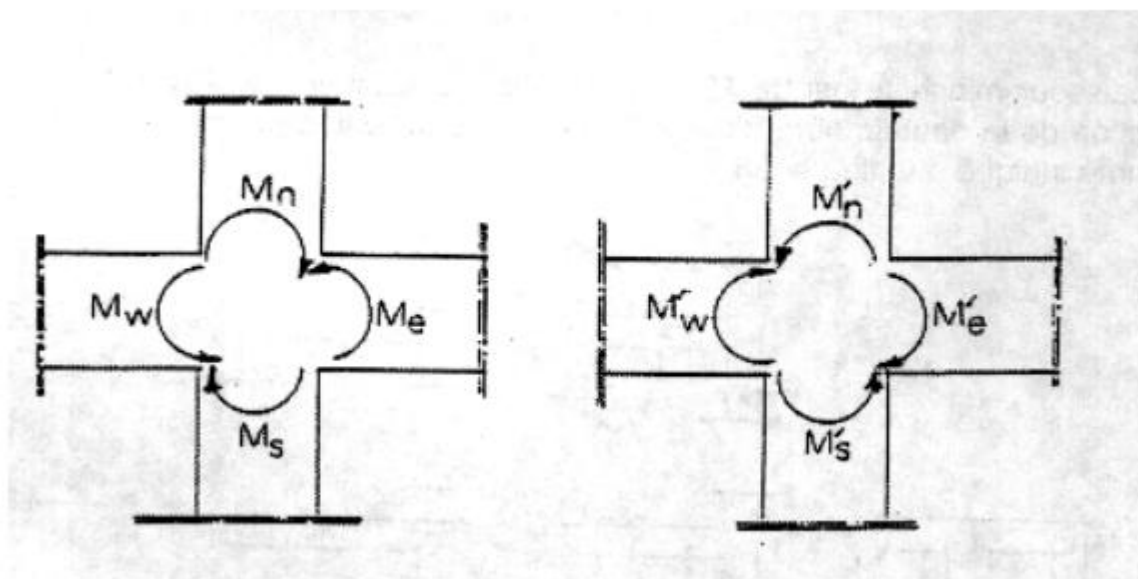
Dimensionnement d'un nœud poutre-poteau [2]
